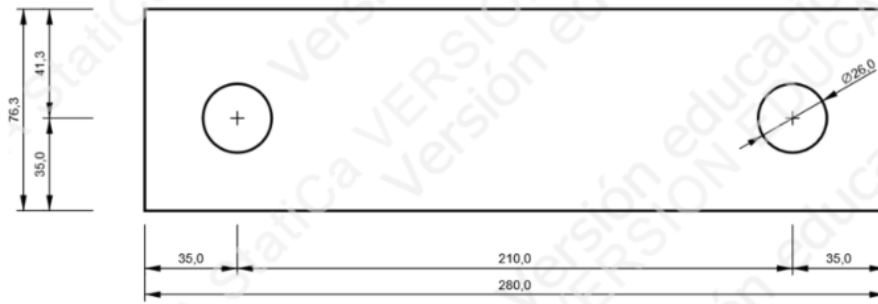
Placa de refuerzo de la unión de IPE330 sin cartela
